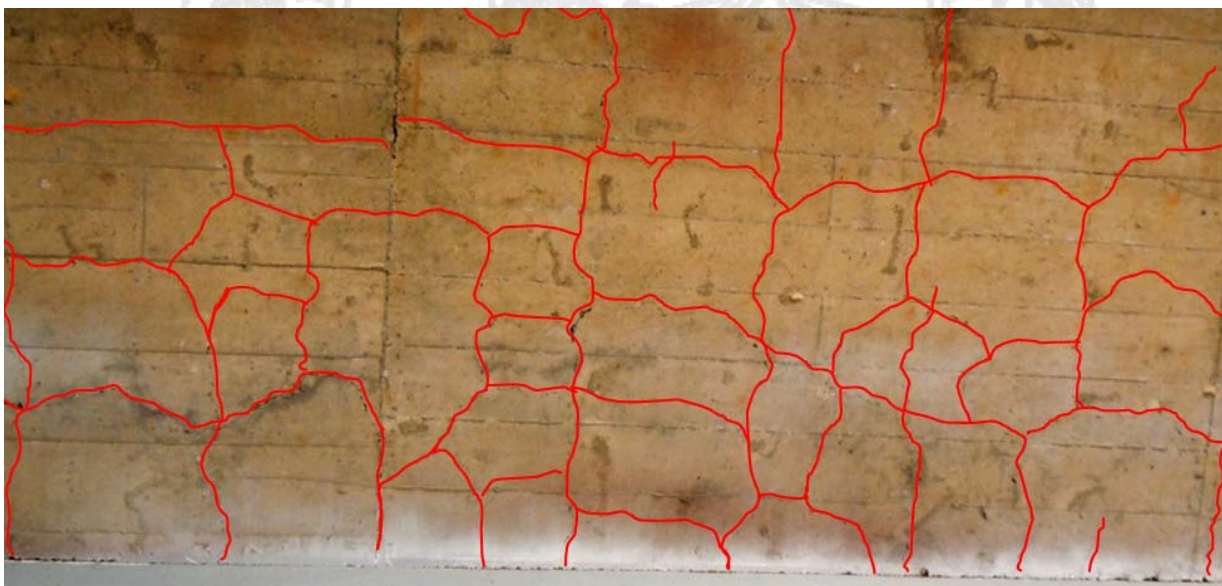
Agrietamiento en red de la superficie inferior de la losa de concreto.
